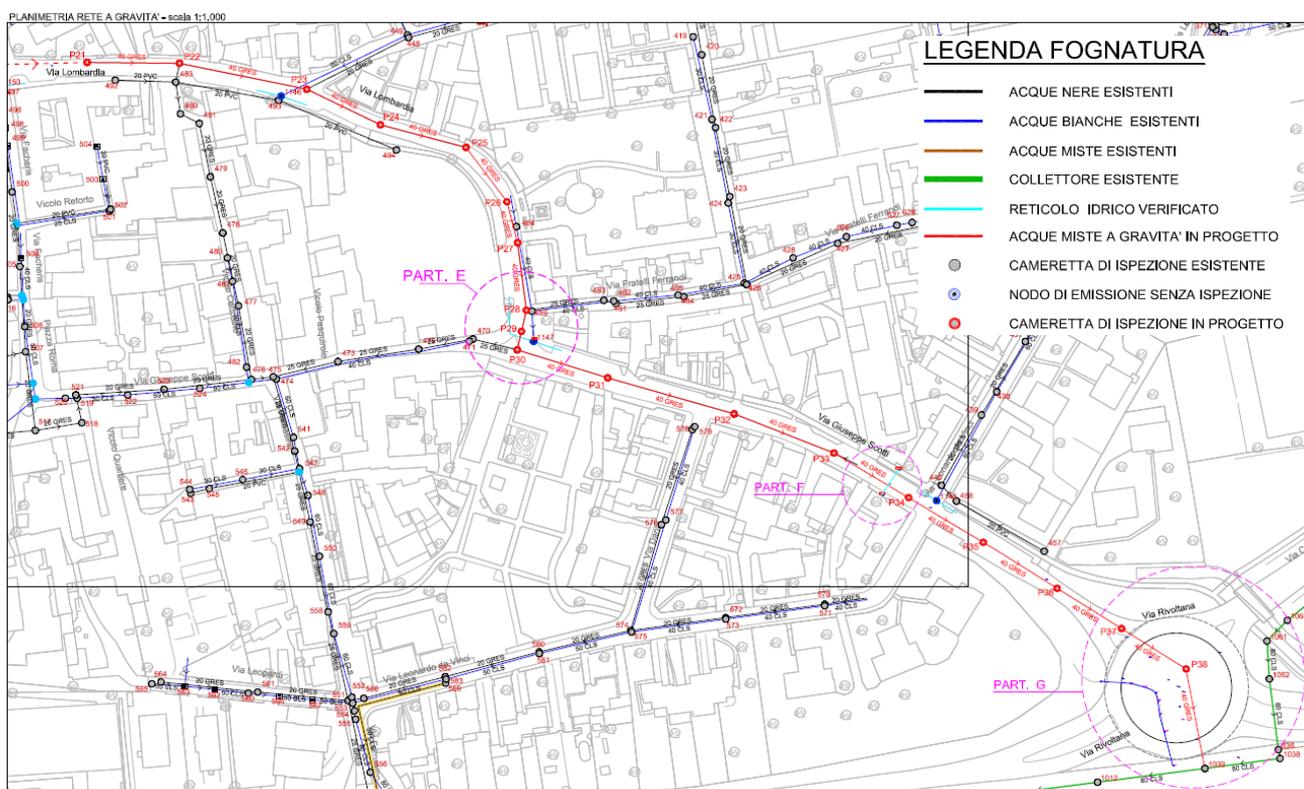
Planimetria Stato di Progetto – rete a gravità
